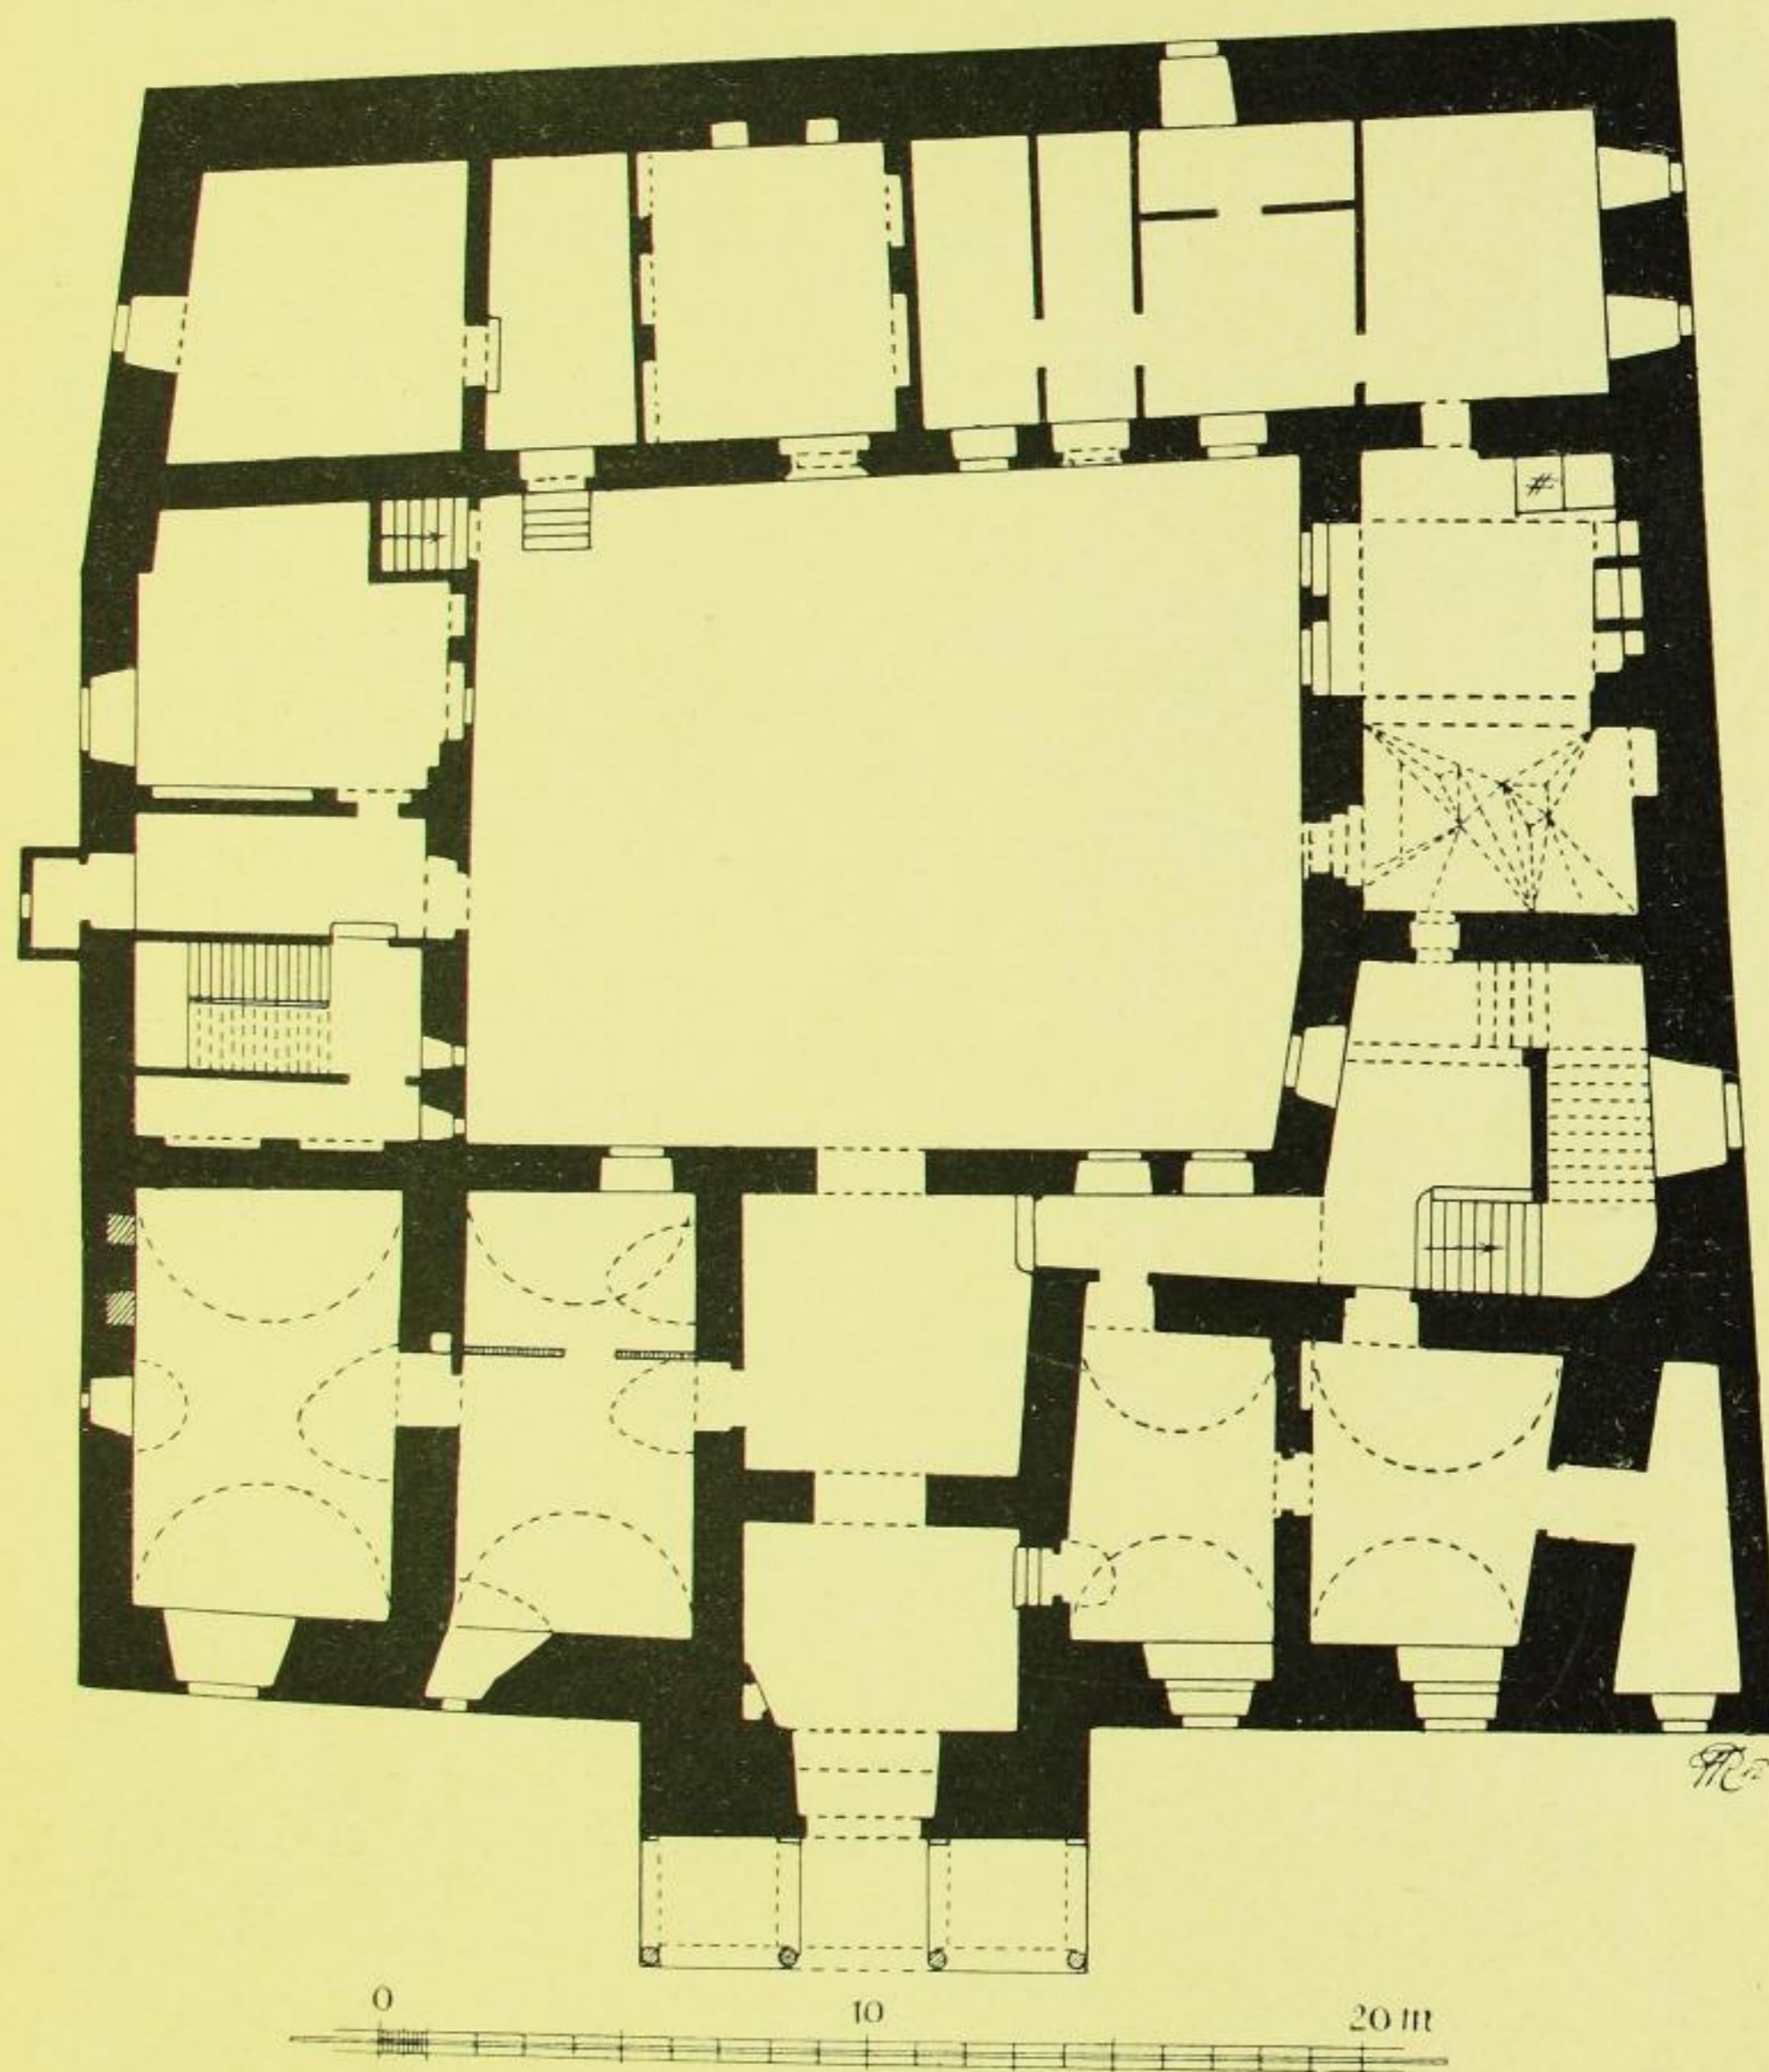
Frauenhain, Schloß, Grundriß des Erdgeschosses.
